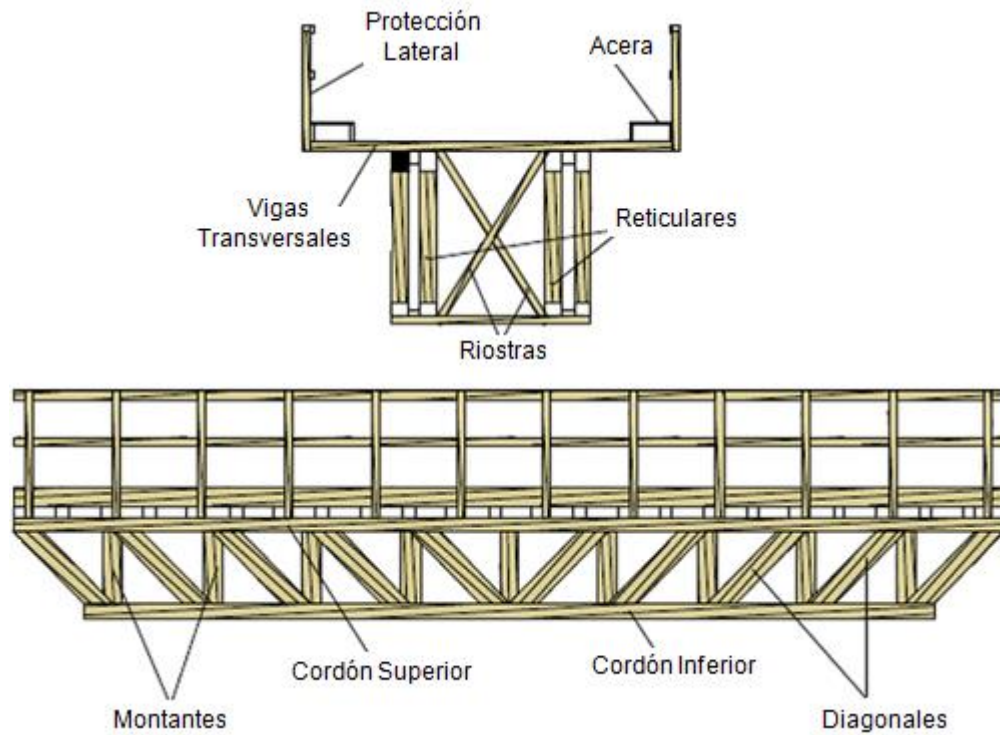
Secciones transversales con vigas en celosía tipo Howe [14]
